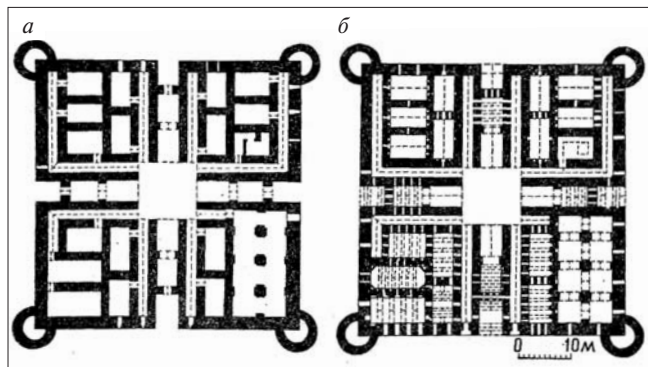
Усадьба Кырк-Кыз в Термезе: а – планы помещений; б – планы перекрытий
